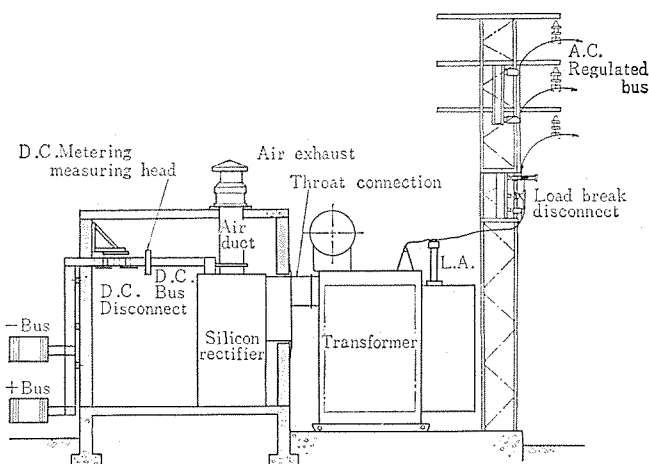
シリコン整流装置配置断面図 (ALCOA 標準形)
